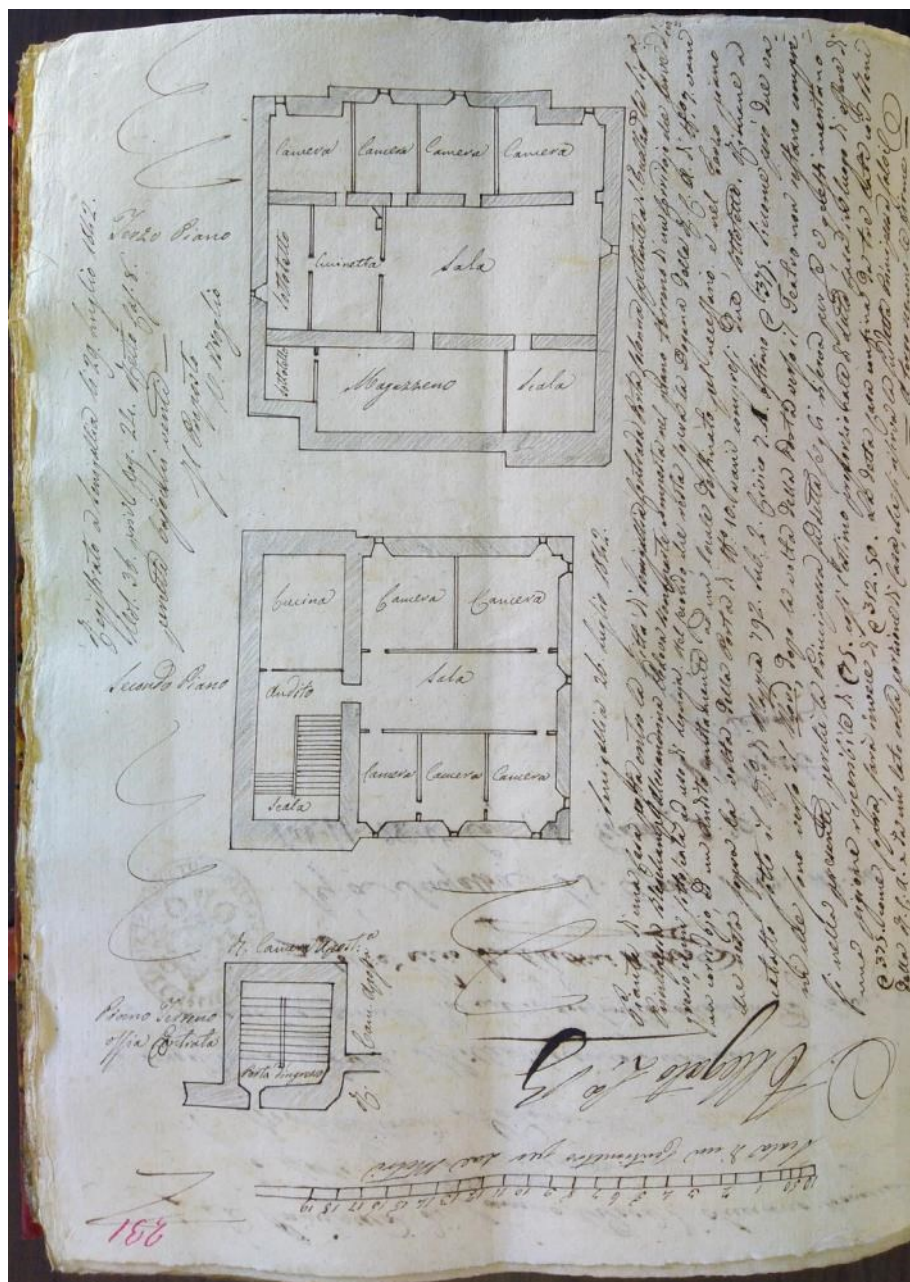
Pianta della casa di Alessandrina Bleschamp a Porta Colonna
